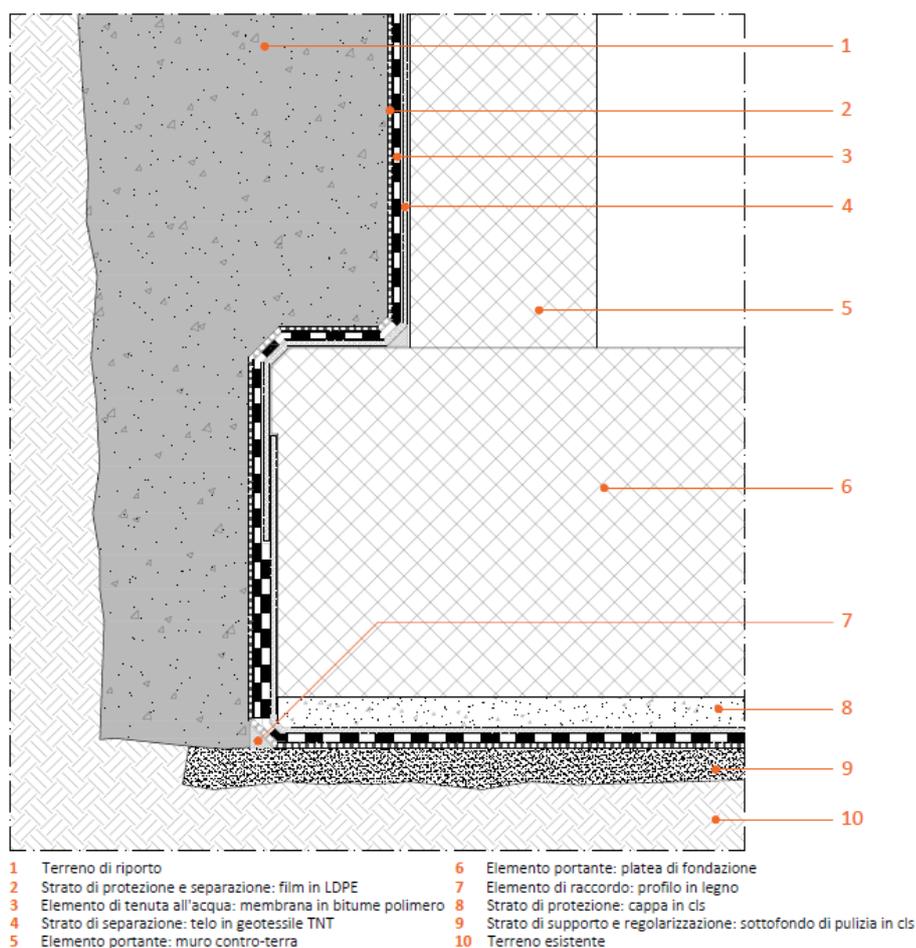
Sistema a sacchetto esterno Ae (per la parete) e esterno rovescio Aer (per la platea)
